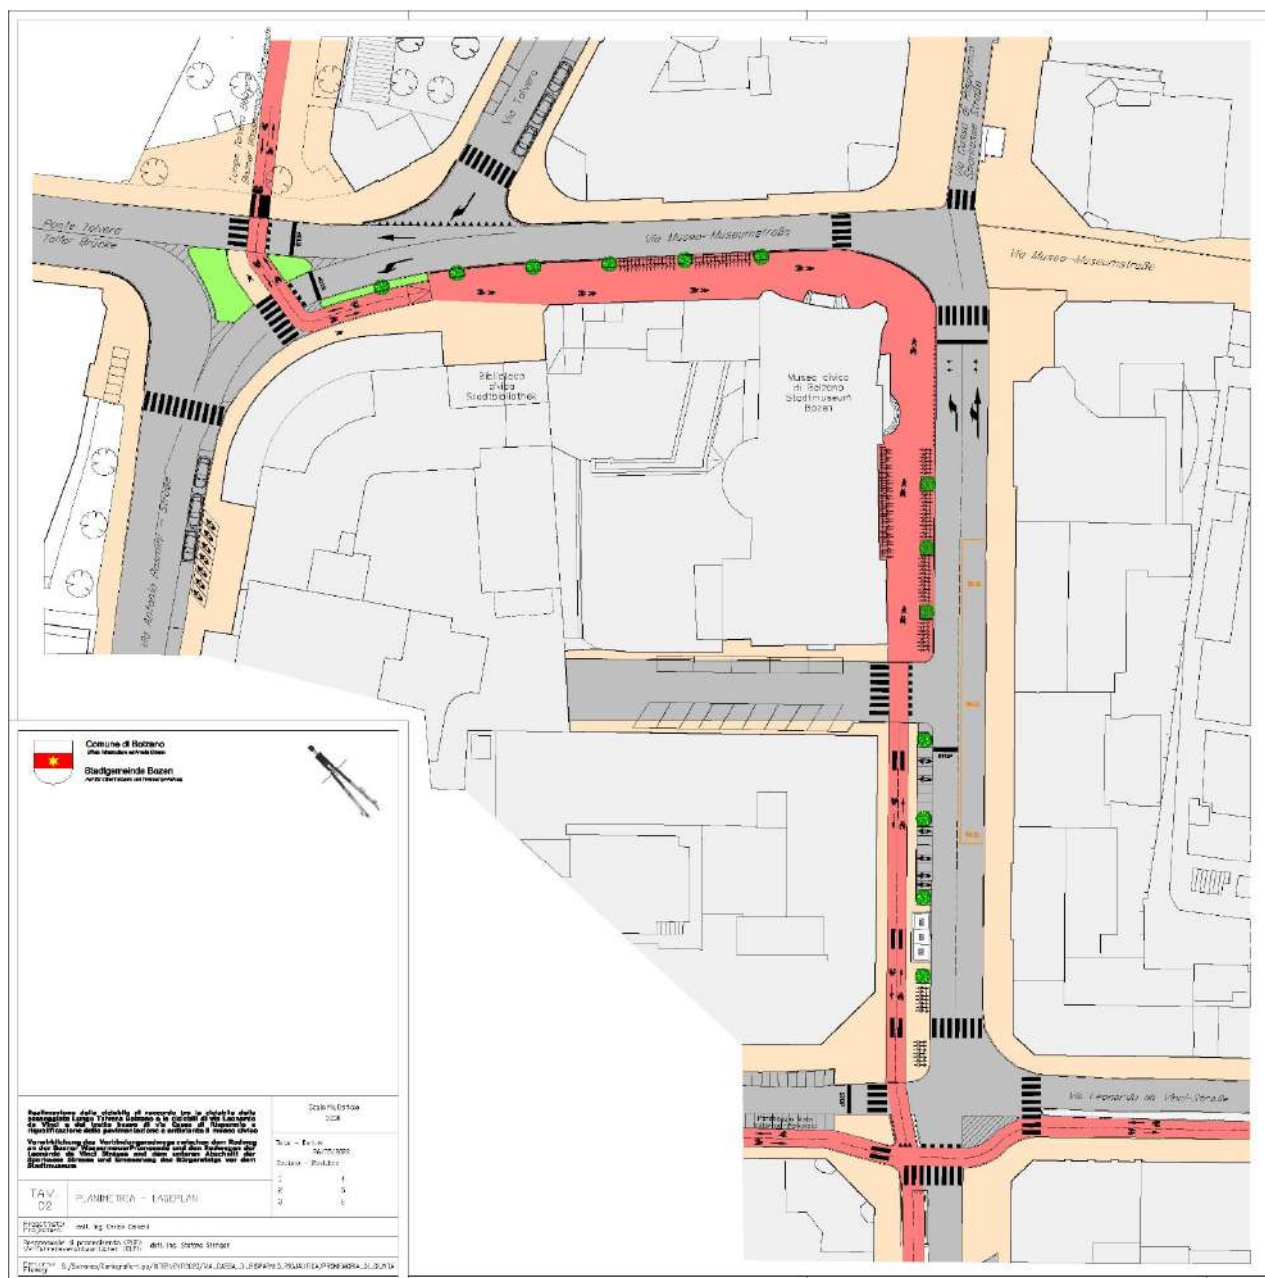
Ciclabile in via Cassa di Risparmi e via Museo (6) - Planimetria di progetto
